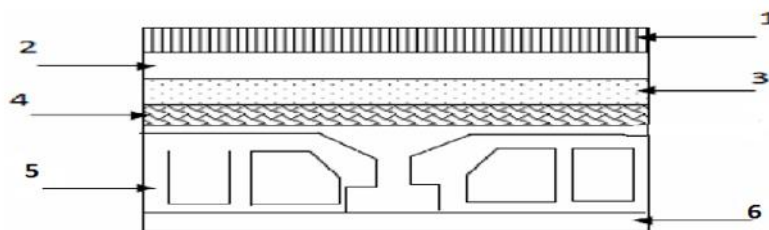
Coupe Transversale du plancher terrasse inaccessible.
